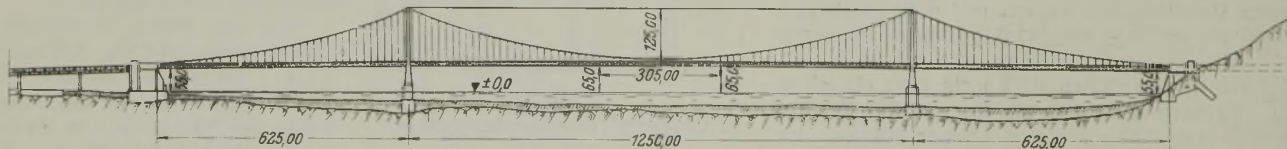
Kabelhängebrücke mit einer Mittelöffnung von 1250 m und zwei Seitenöffnungen von je 625 m Spannweite.
